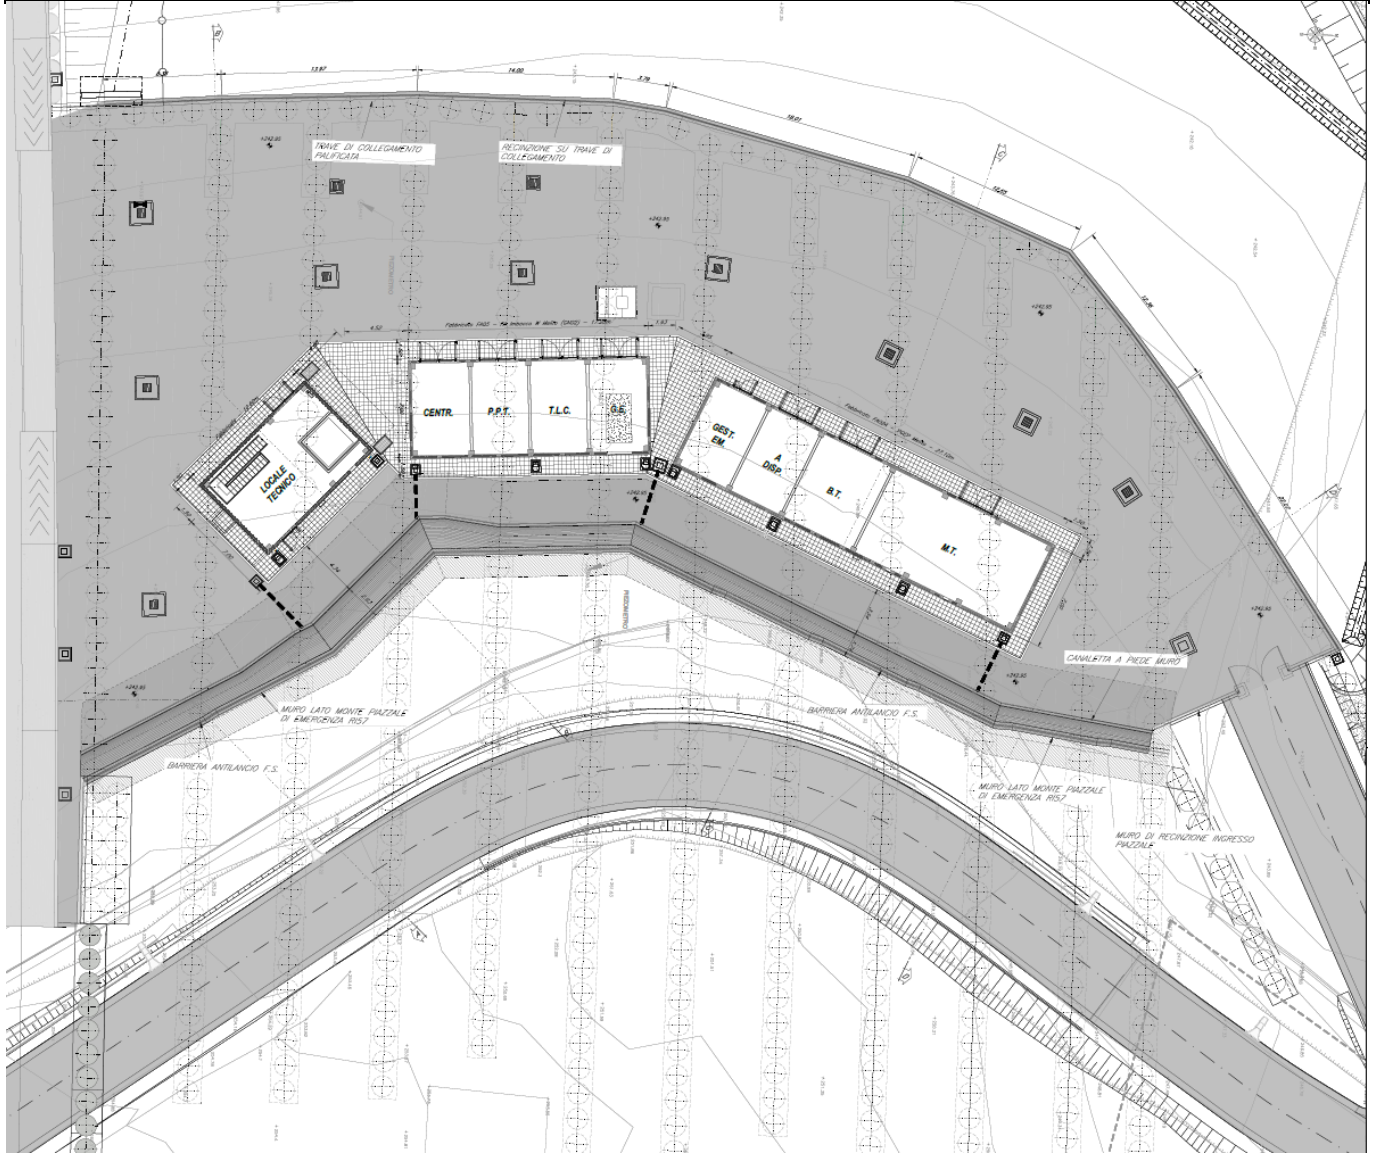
Vista in pianta delle opere Piazzale RI57 (Doc. Rif. [22])
